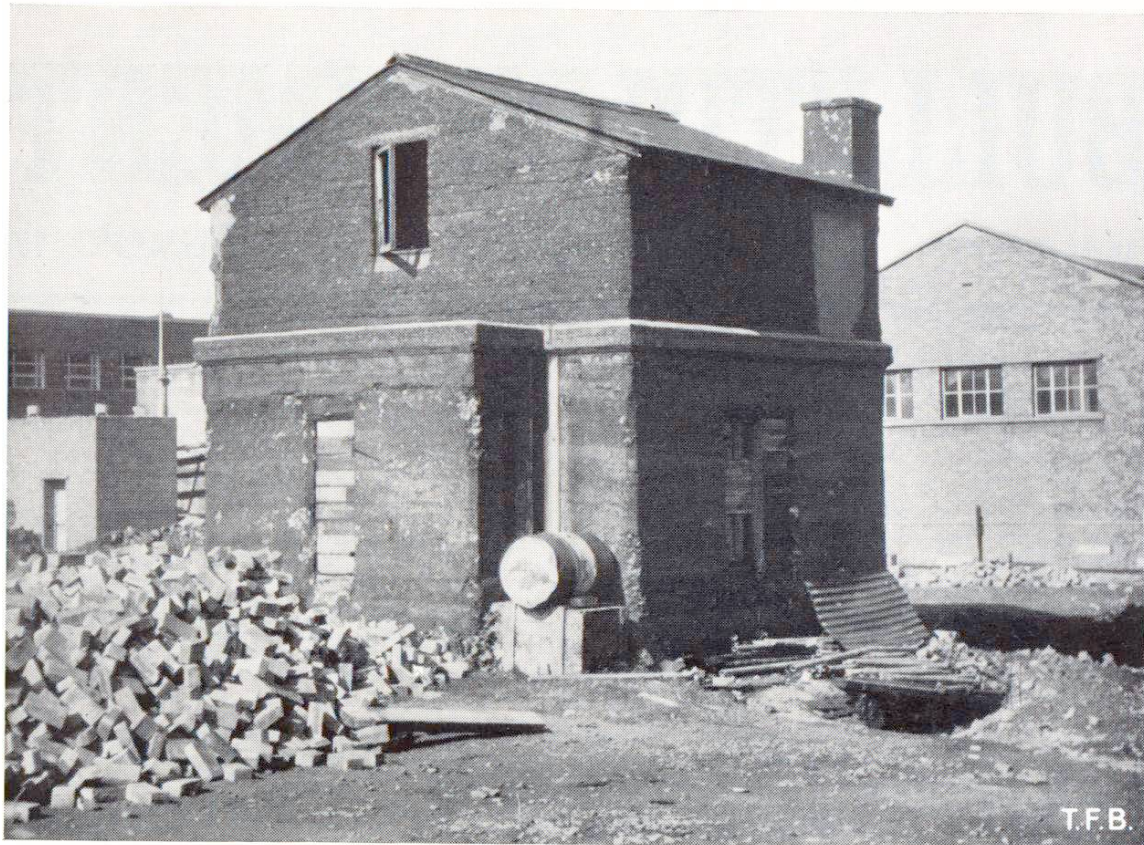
La maison en béton armé de Wilkinson à Newcastle upon Tyne
